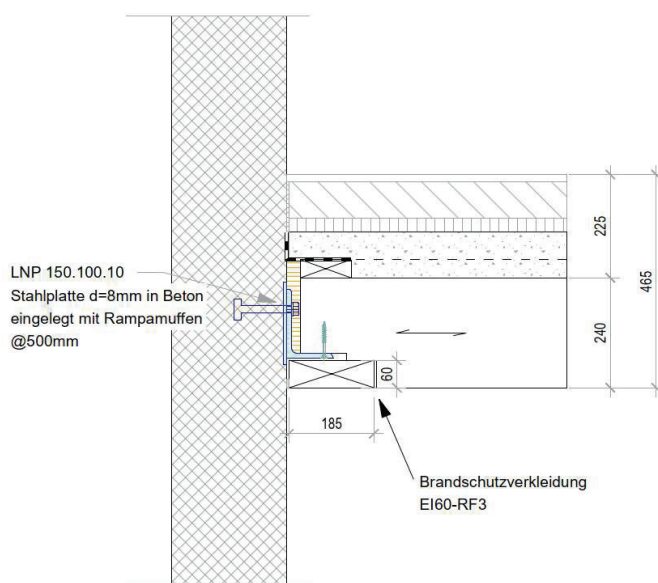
Anschluss der Holzdecken an Stahlbetonkerne mittels LNP-Stahlprofilen, Grafik: Timbatec Holzbauingenieure
